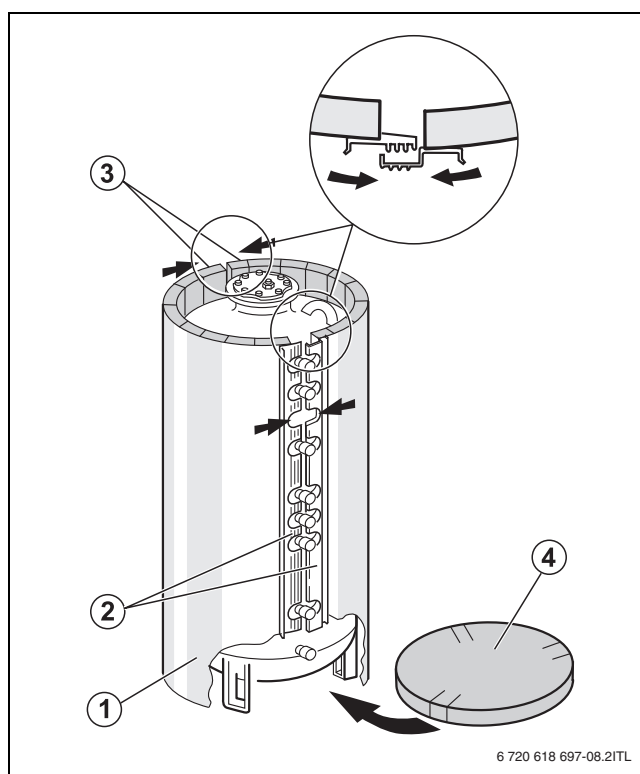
Wärmedämmung montieren (Ansicht von hinten)
